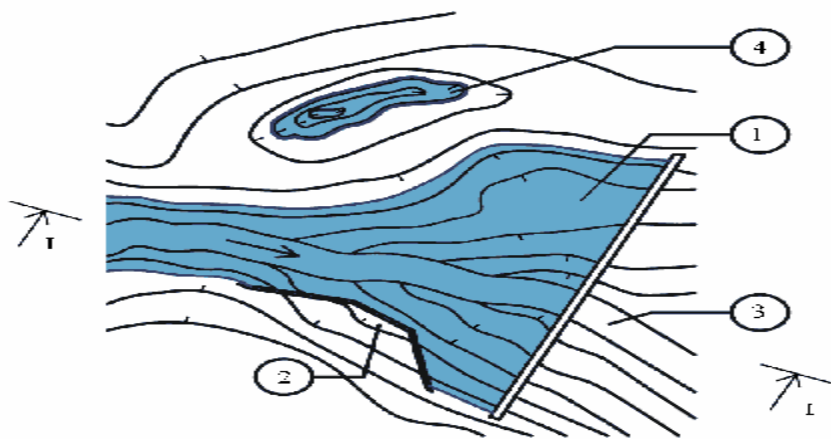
План гидроузла и отмеченных на топокартах водоемов:
